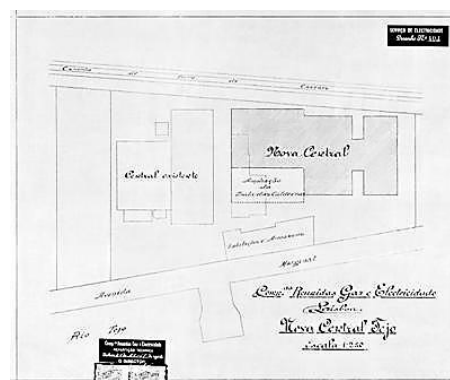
Planta com ampliação dos terrenos para a construção da nova Central Tejo. Fonte: Arquivo da Fundação EDP, <http://wikienergia.com/~edp/> [Consult. 20 Maio 2011].
